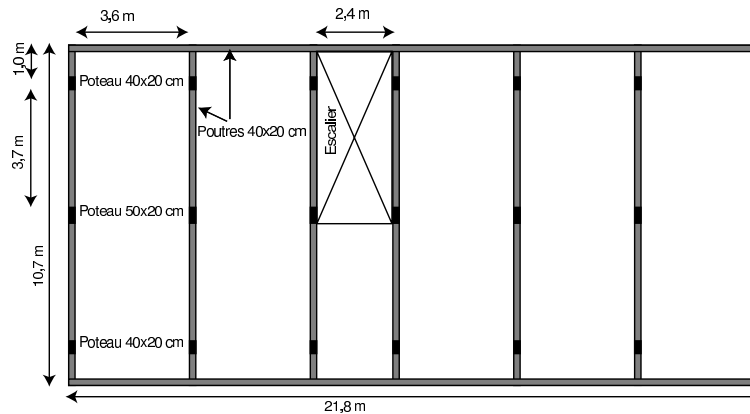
Vue en plan d'un étage d'un bâtiment de la Cité des 1200. Les poutres sont représentées en gris et les poteaux en noir.
